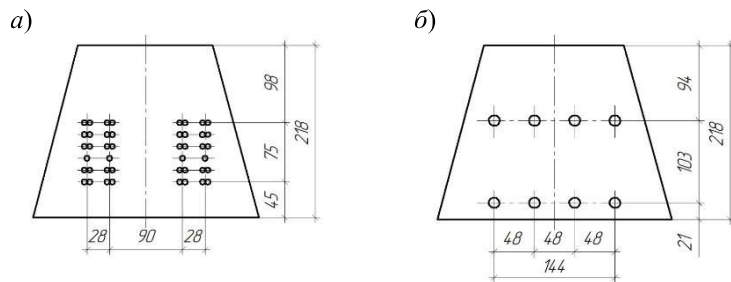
Поперечний переріз залізобетонної шпали (а) і бетонної з композитною арматурою (б) в підрейковій зоні
